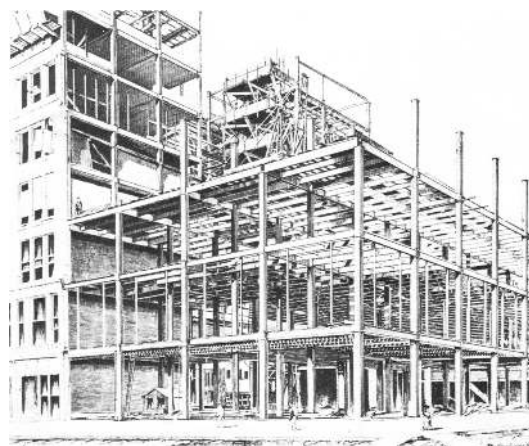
Construction du Fair Store Building à Chicago (1891)
